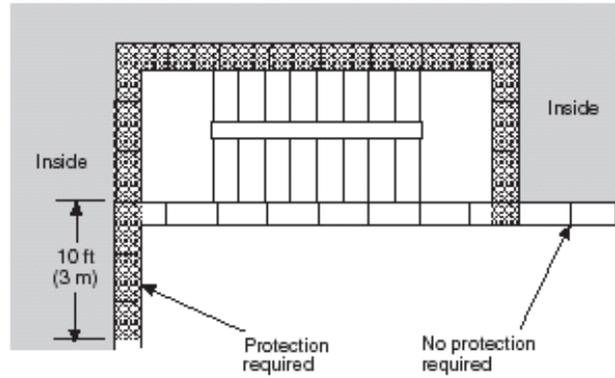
CAJA ESCALERA CON UN MURO EXTERIOR Y PROLONGACIÓN DE UN MURO INTERIOR
